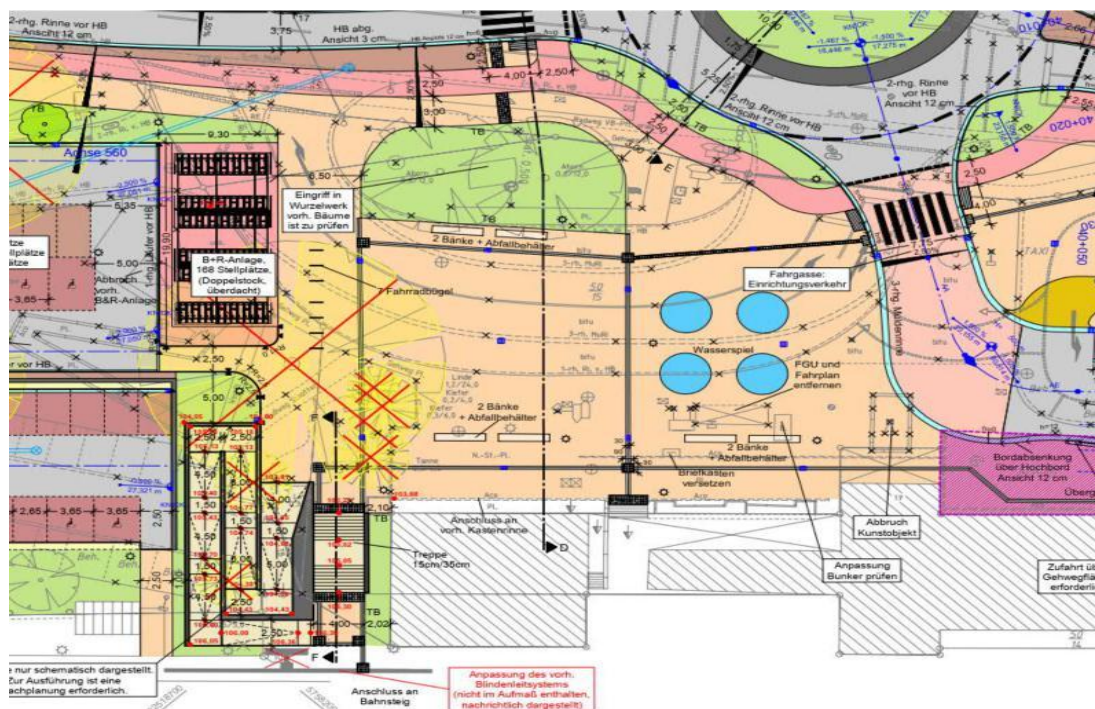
Lageplan Bereich Bahnhofsvorplatz
